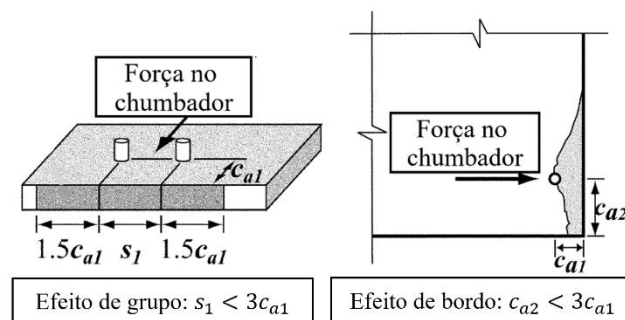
Vista de cima e de lado da pirâmide de falha do concreto solicitado por força cortante
